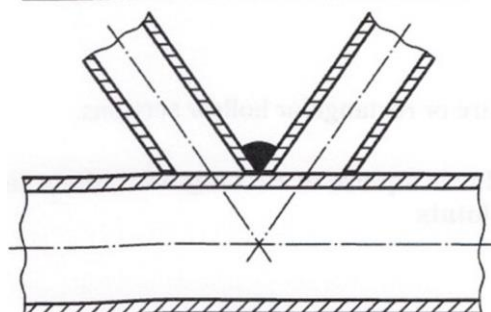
Przygotowanie spoiny i montaż dla połączeń ukośnych kształowników drążonych
